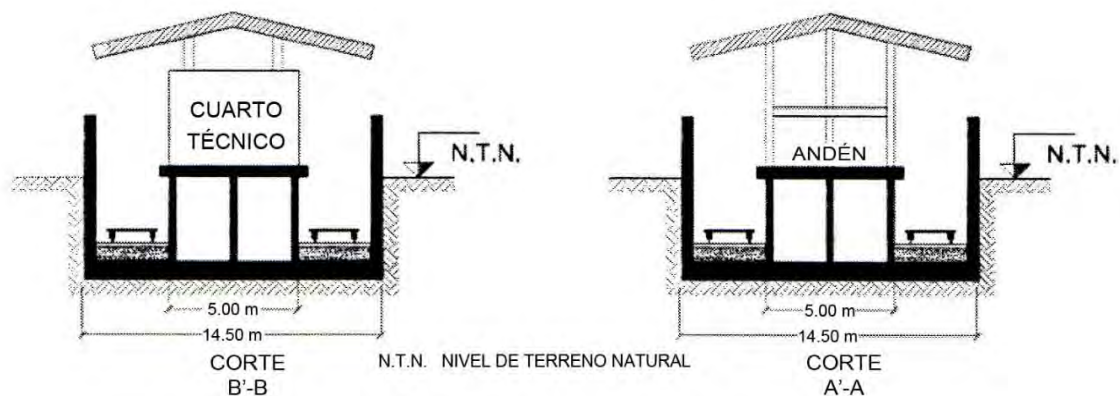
Cimentación en cuarto de máquinas y zona de andenes.
